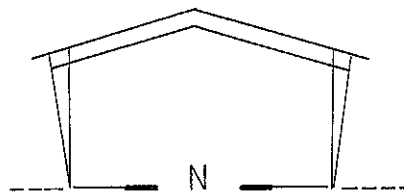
Placa de Apoio em Chapa Dobrada, Soldada com Tirante
